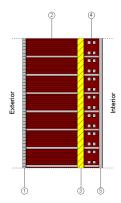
Cerramiento Muro exterior Sur-Este -Oeste
